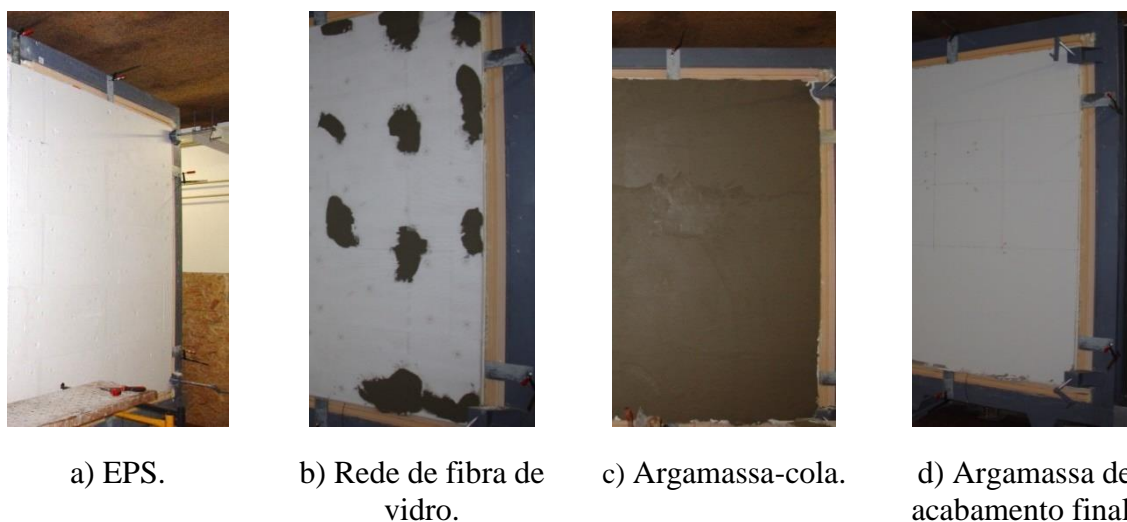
Aplicação do ETICS na face exterior da parede no pórtico de ensaio.
